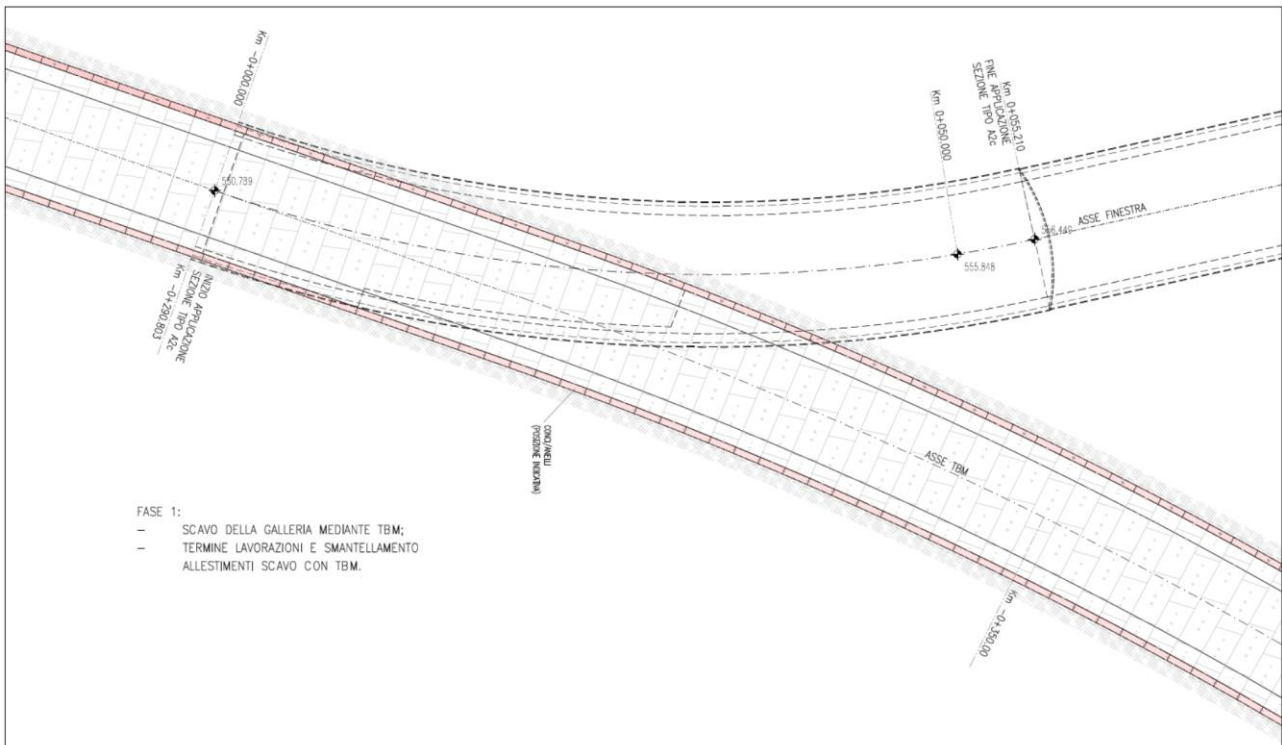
Biforcazione finestra tradizionale e TBM - Fase 1
